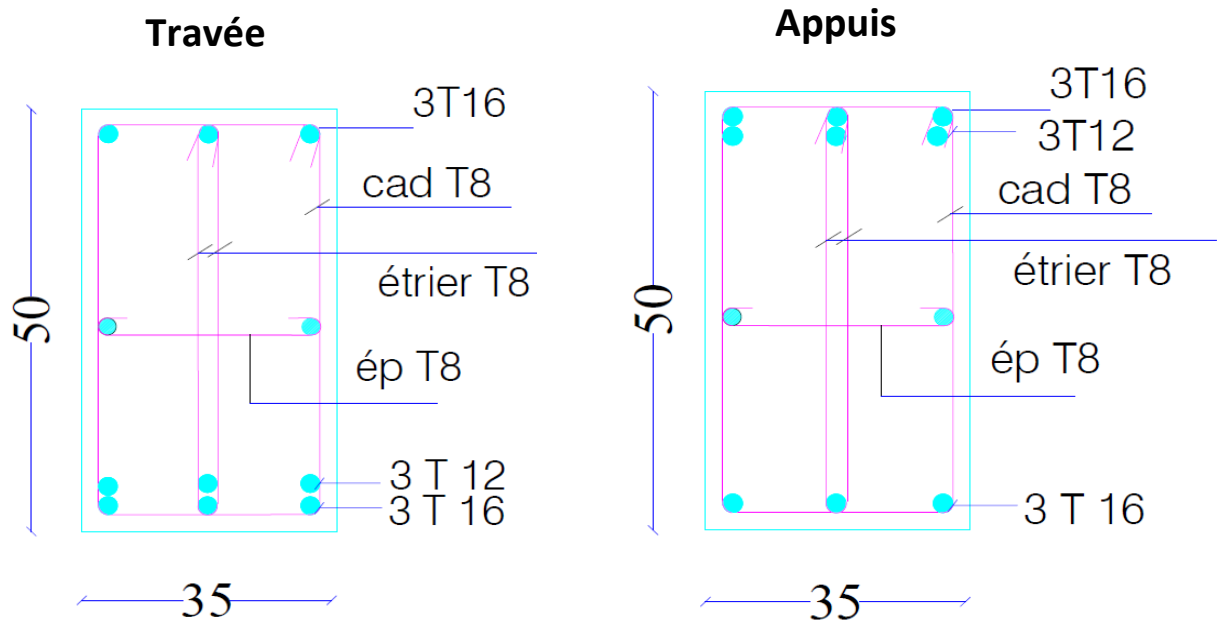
Ferrailage de la poutre principale (35× 50) cm².
